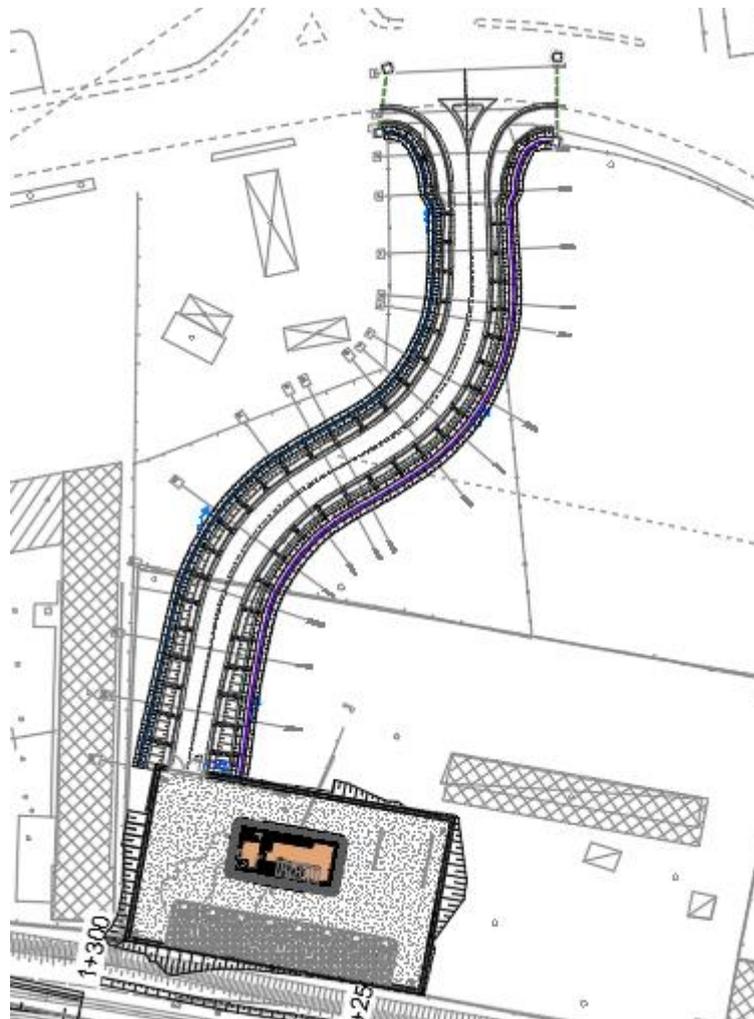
Stralcio planimetrico drenaggio viabilità NV01
